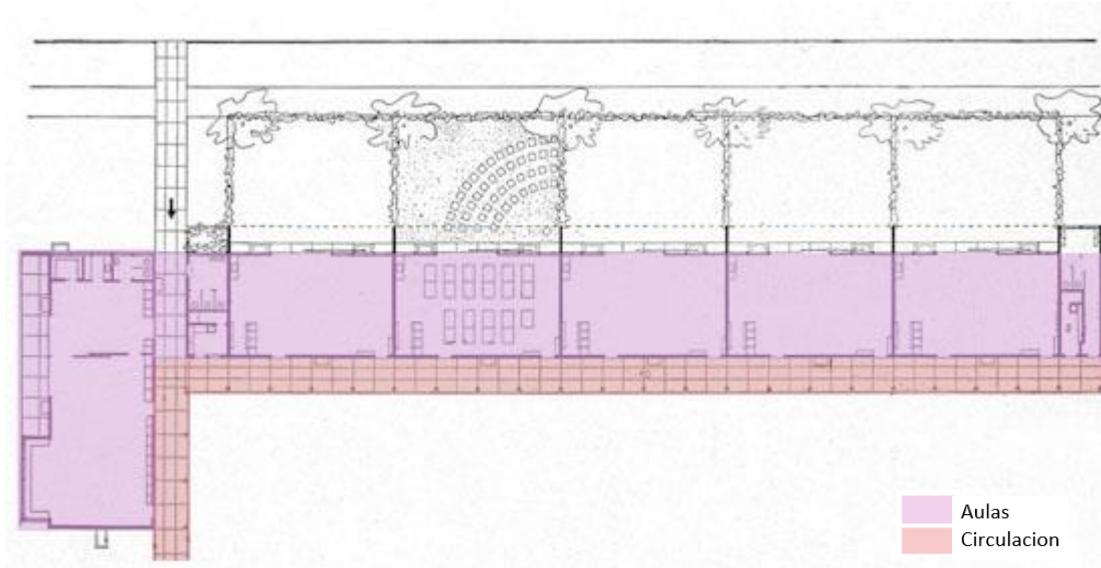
Plano de planta del proyecto “Corona Avenue School”, se puede observar la zonificación de la planta en forma de “L” donde las aulas se encuentran conectadas por medio del corredor exterior. Neutra, Richard (1935).
